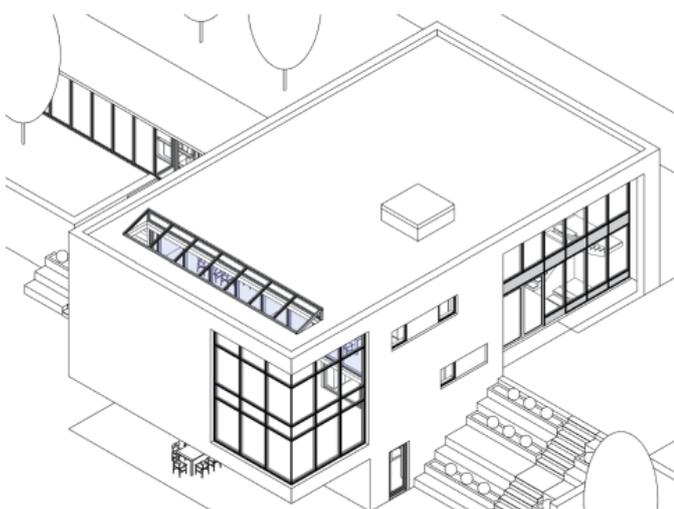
Als Gebäudemodell wurde ein Multifunktionales Gebäude entwickelt, in dem sich möglichst viele Produktgruppen demonstrieren lassen.
